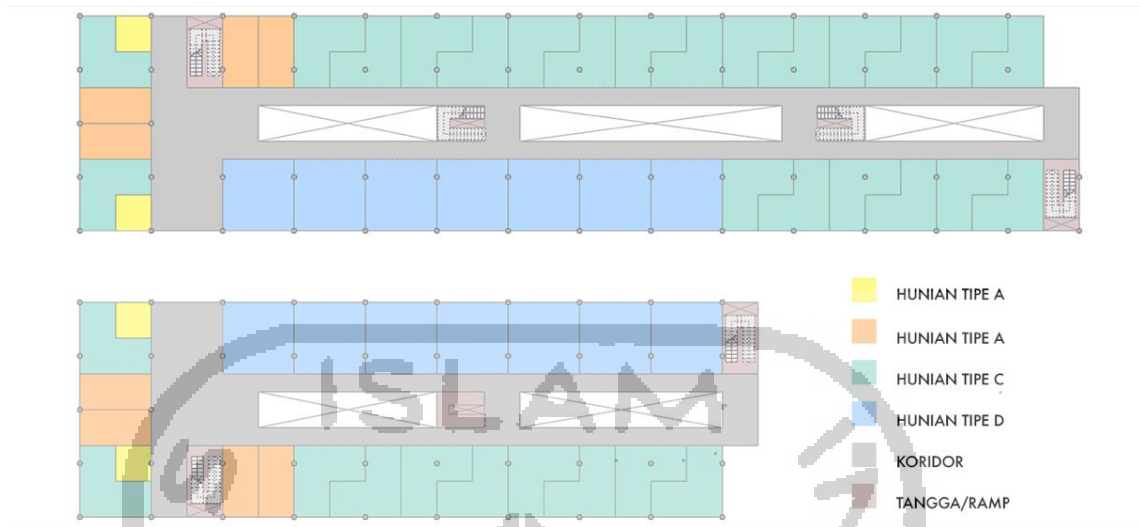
13 Konsep Zonasi 1st Floor (tipikal)
